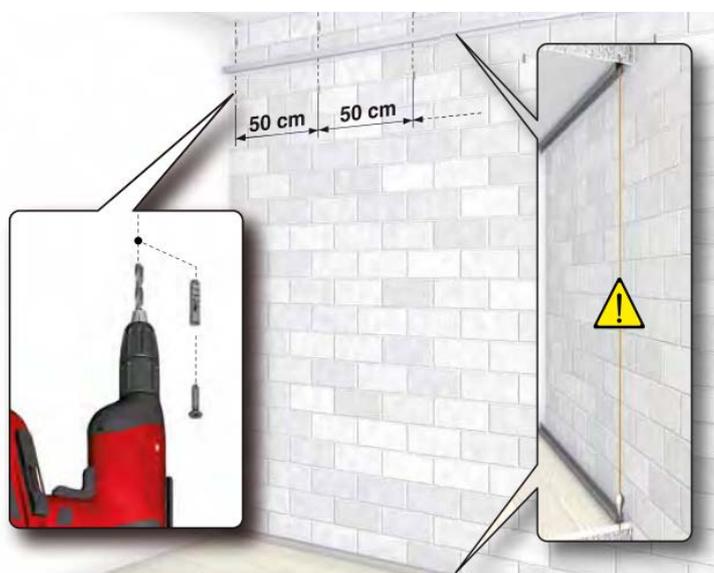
La fase successiva di montaggio del profilo guida principale
